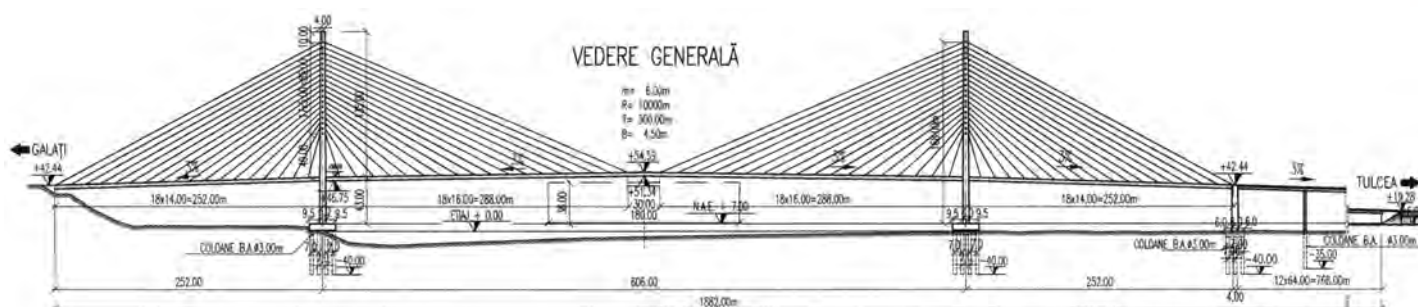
Pod hobanat cu platelaj din metal cu placă din beton armat
